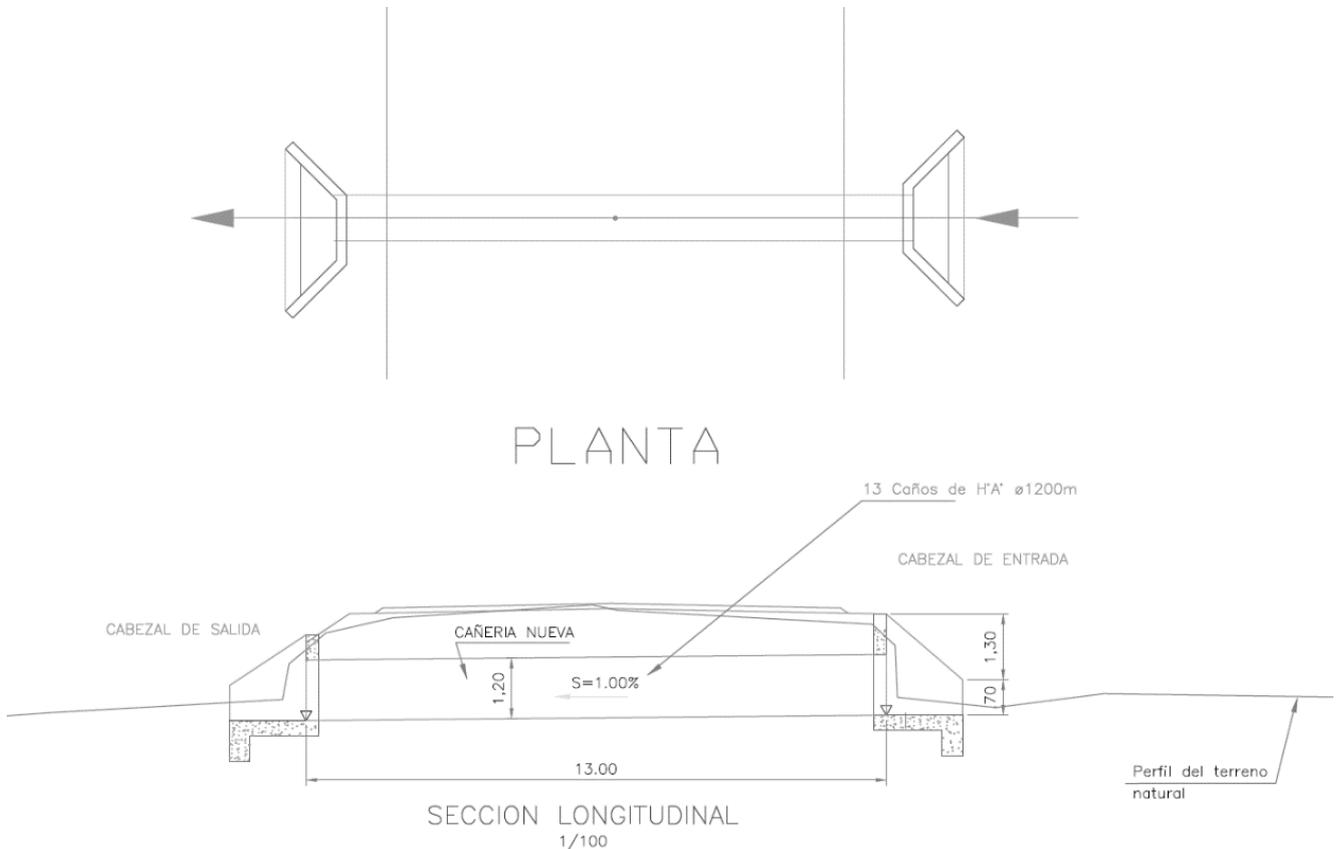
Vista en Planta y Sección longitudinal de las alcantarillas del proyecto
